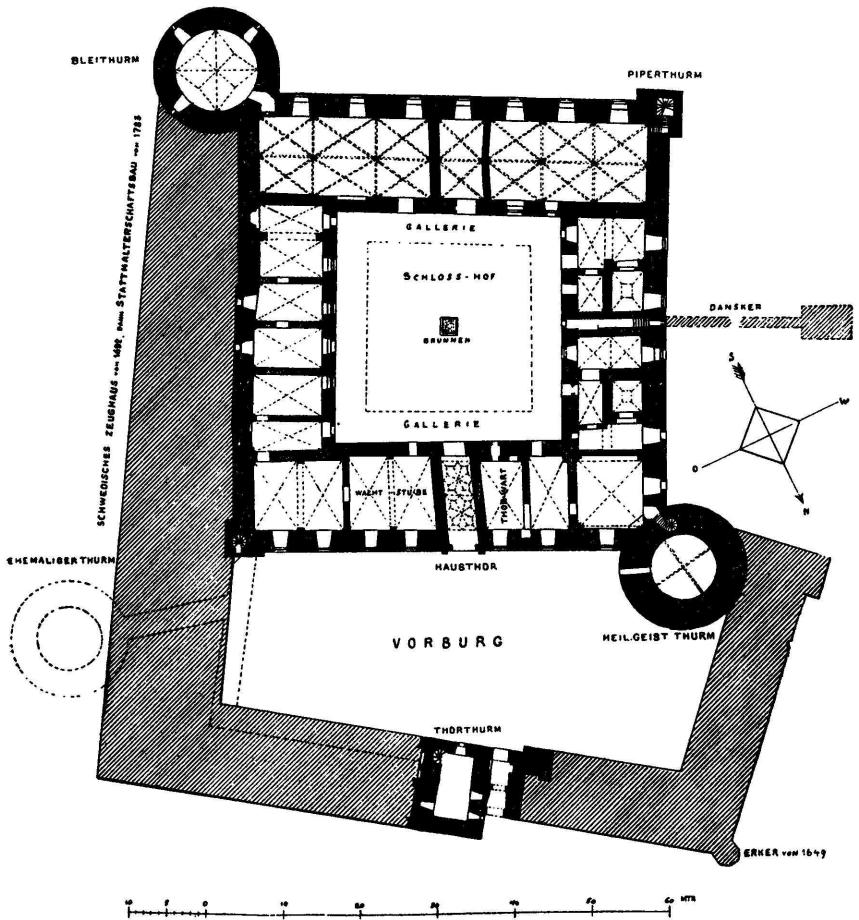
Grundriss des ersten Stockwerks des Schlosses. Nach Neumann.
